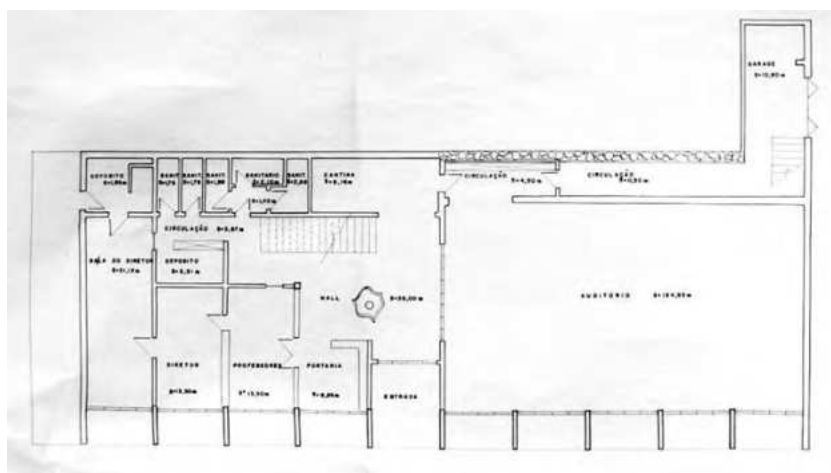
Fotografia da planta baixa do pavimento térreo sem data. Fonte: Mapoteca da UFBA.
